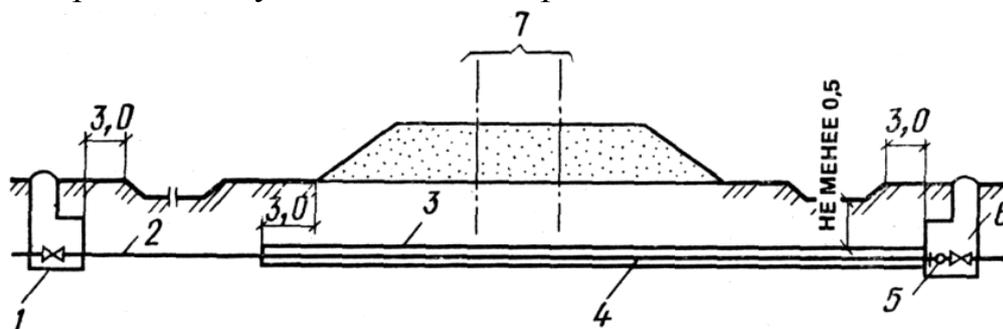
Переход водопроводных линий под железнодорожными путями:
